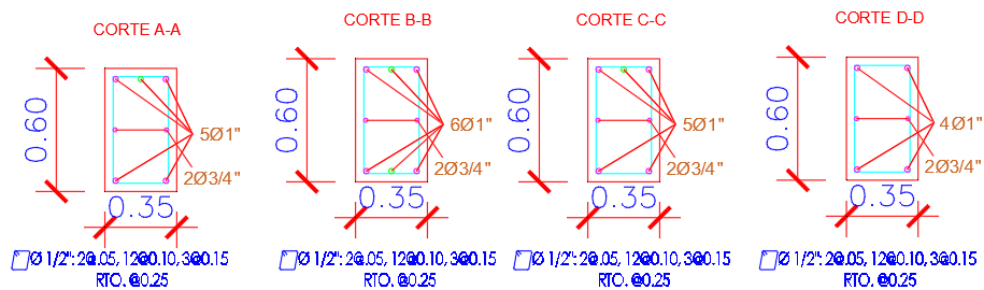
Secciones de Viga con Refuerzo 7° Piso
